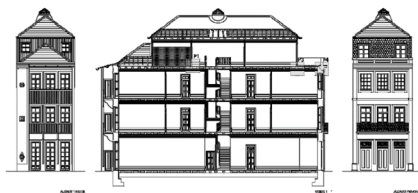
Modelo construtivo das casas burguesas do Porto – planta do piso recuado, corte longitudinal e alçados da rua e de tardoz (Teixeira & Povoas, 2009).
